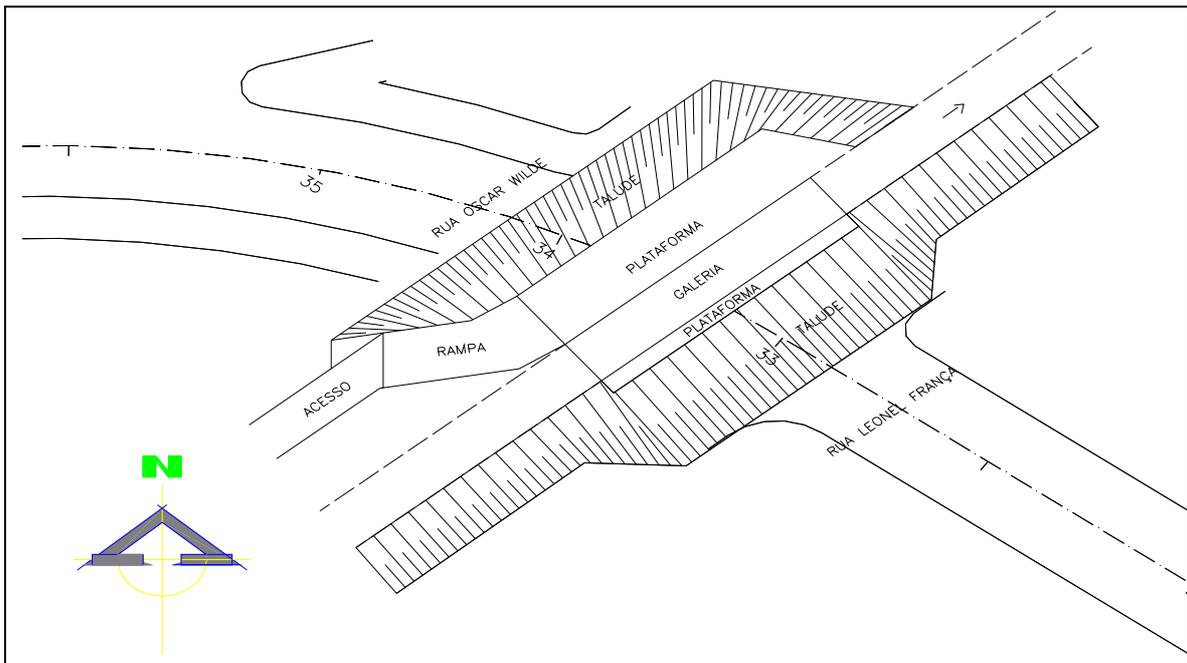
Planta esquemática da configuração dos taludes durante as obras
